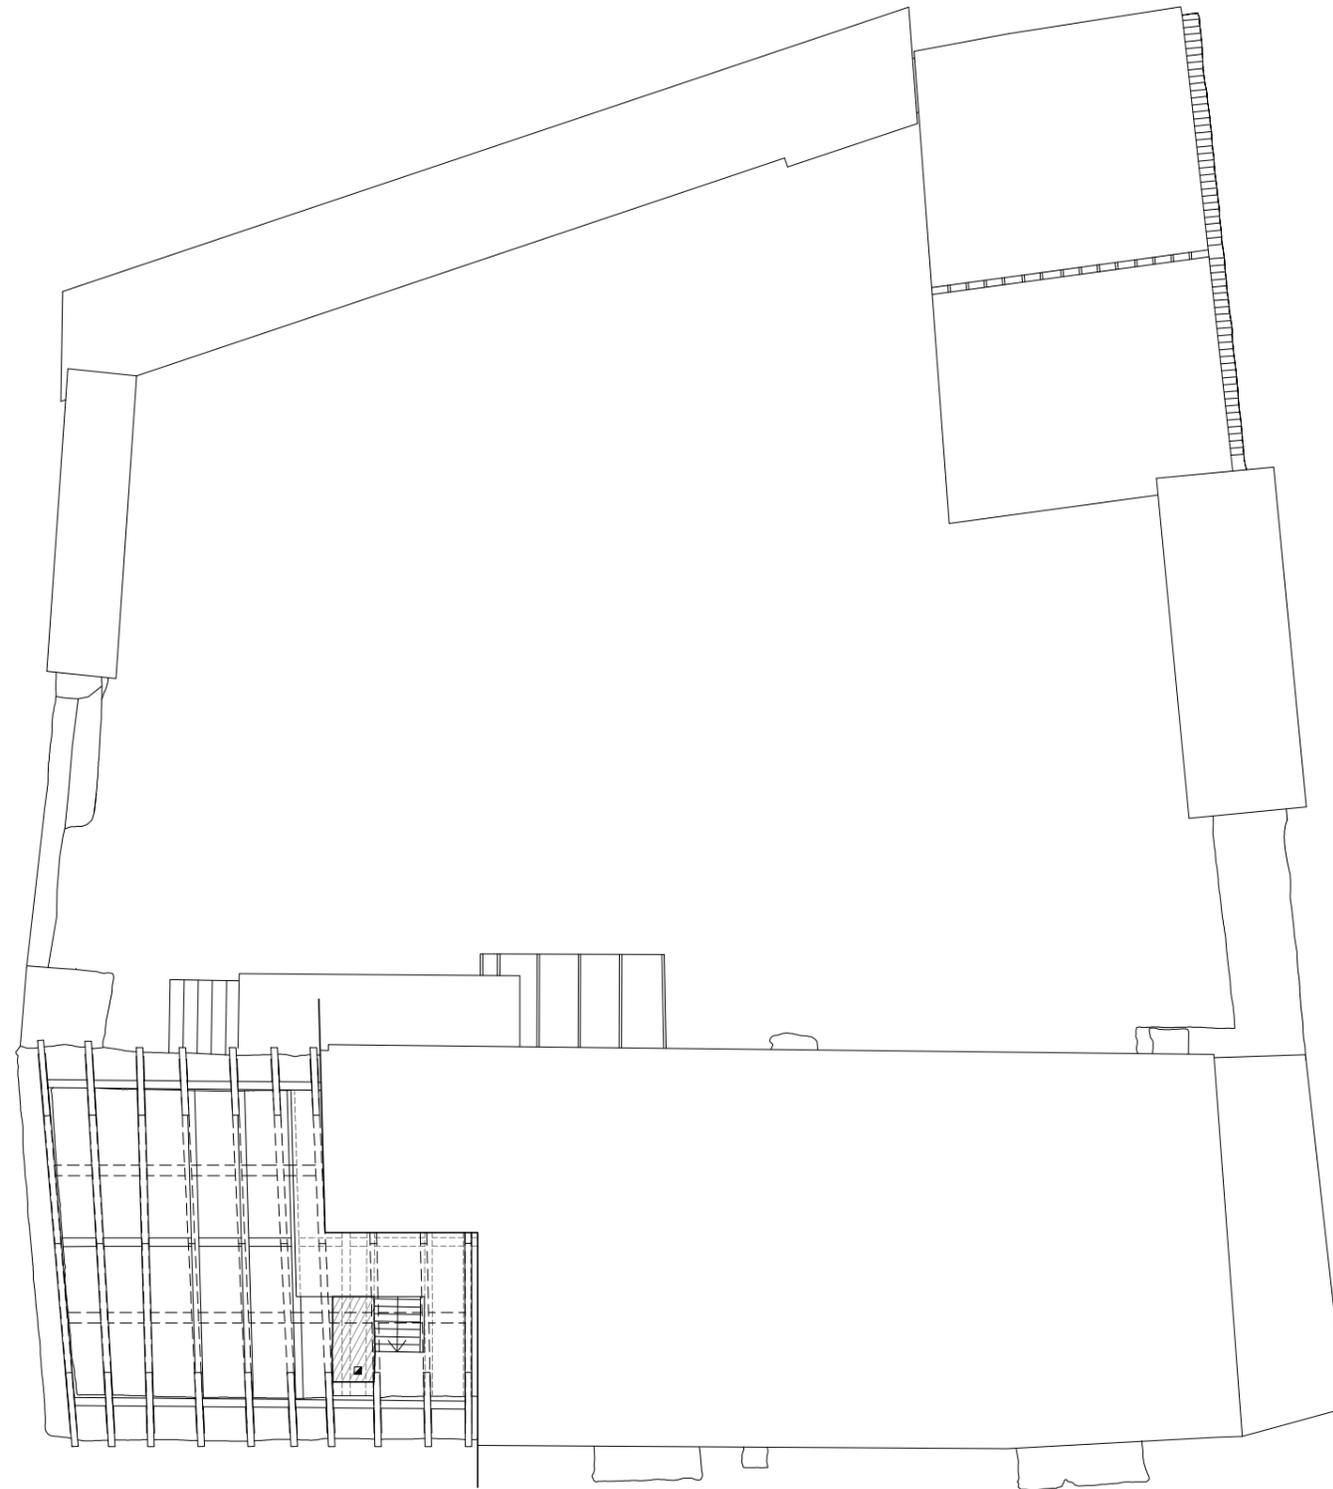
Bestandsplan, Dachgeschoß, M 1:150
